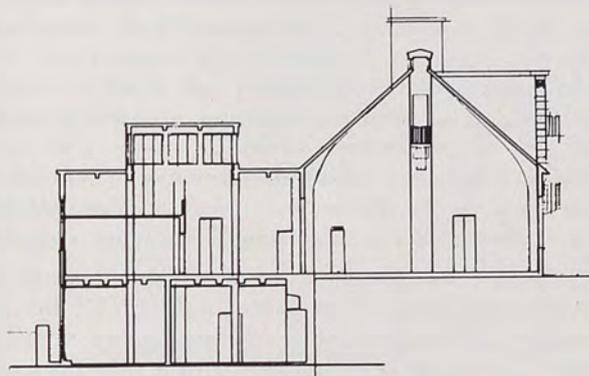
Bagni e lavatoi del Quartiere San Donato, sezione trasversale sul locale lavatoi, prima dell'intervento.
